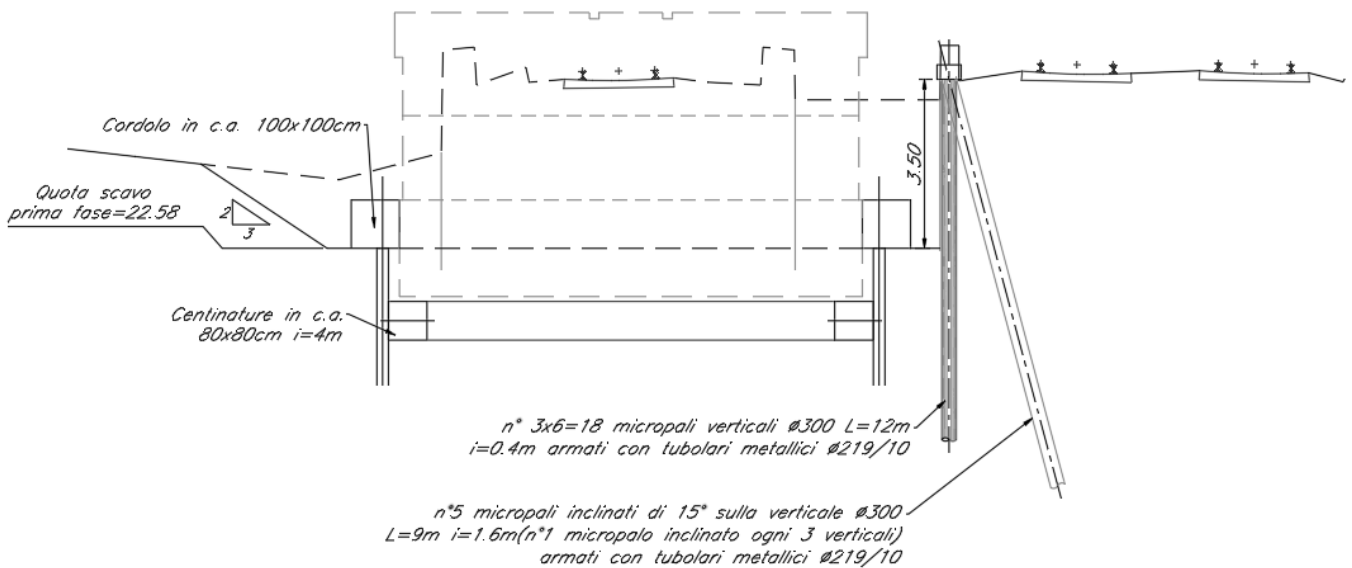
Sezione Opere Provvisionali Spalla A
